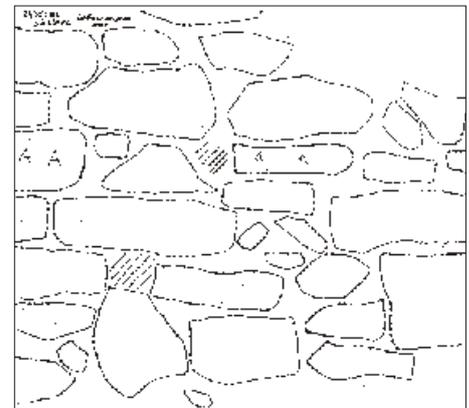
Rilievo estremità ovest muro settentrionale (pm1 nella planimetria). Il tratteggio in basso corrisponde ad una buca puntaia; A=arenaria.
